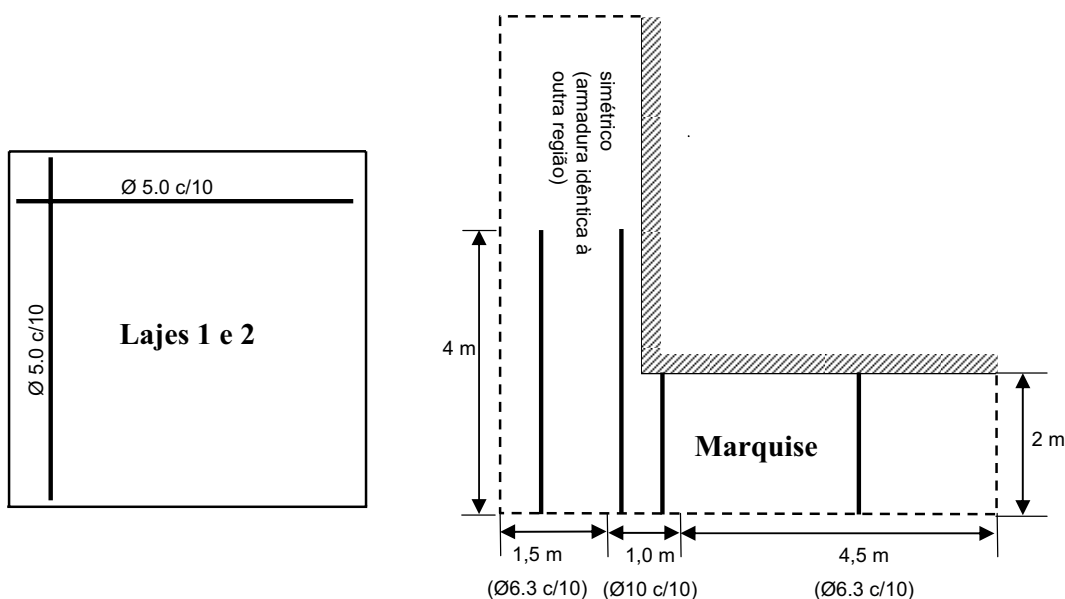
Detalhamento das armaduras para as lajes 1 e 2 e para a marquise.
